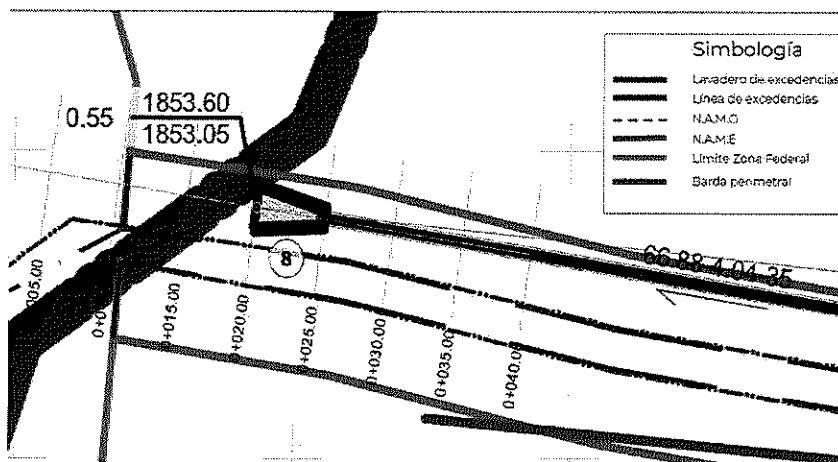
Plano "Coordenadas de obras" MIA-P.
